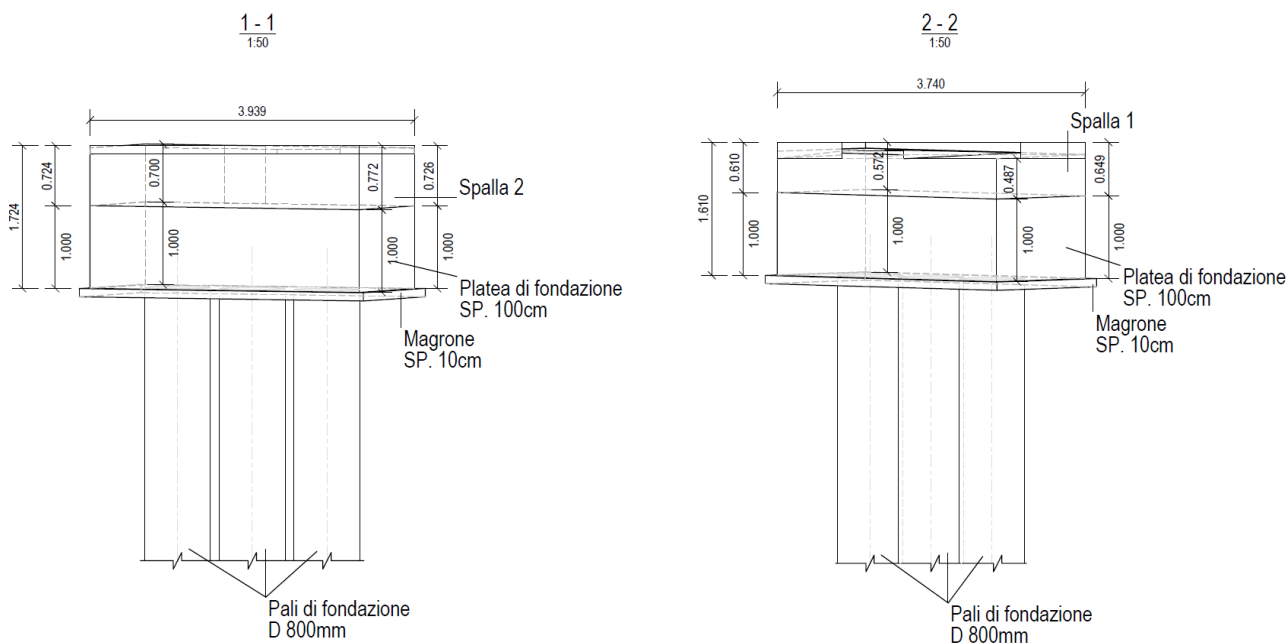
Sezioni trasversali con vista delle due spalle.
